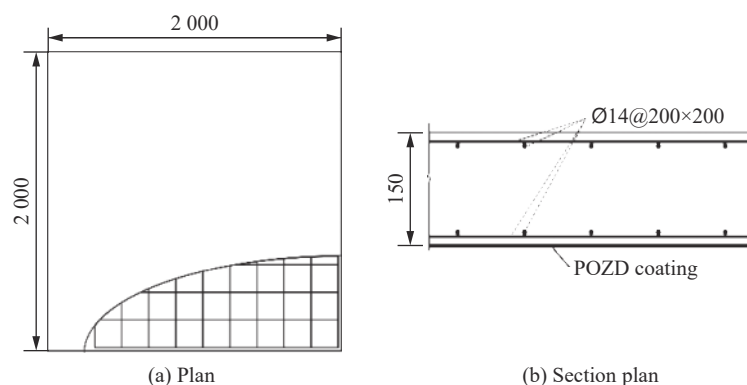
混凝土板配筋及内衬材料示意图(单位: mm)
